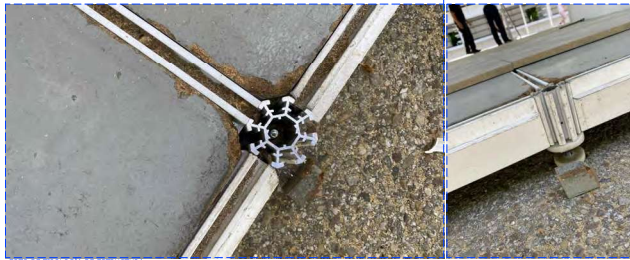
FOTO DE TIPOLOGÍA DE ESTRUCTURA
